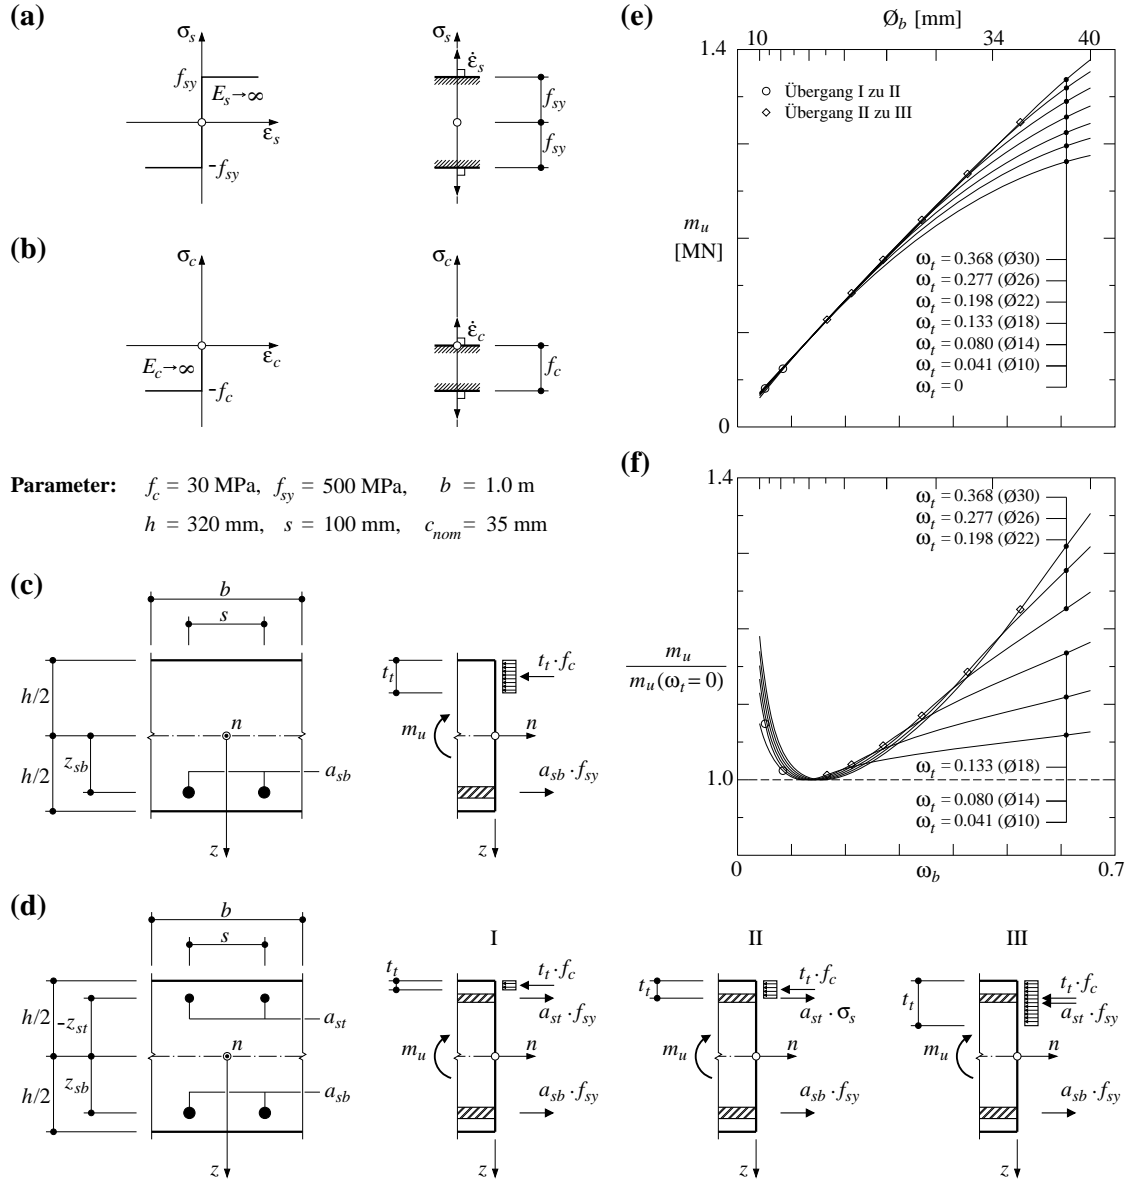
Biegewaterstand eines Plattenelements: (a) Betonstahl unter einachsiger Beanspruchung, starr-ideal plastisches Verhalten, Fließbedingung; (b) Beton unter einachsiger Beanspruchung, starr-ideal plastisches Verhalten, Fließbedingung; (c) Schnittkörperdiagramm ohne Bewehrung auf der Biegedruckseite; (d) Schnittkörperdiagramme mit Berücksichtigung einer Bewehrung auf der Biegedruckseite; (e) Biegewaterstand, (f) Verhältnis der Biegewaterstände in Funktion der Bewehrungen.
